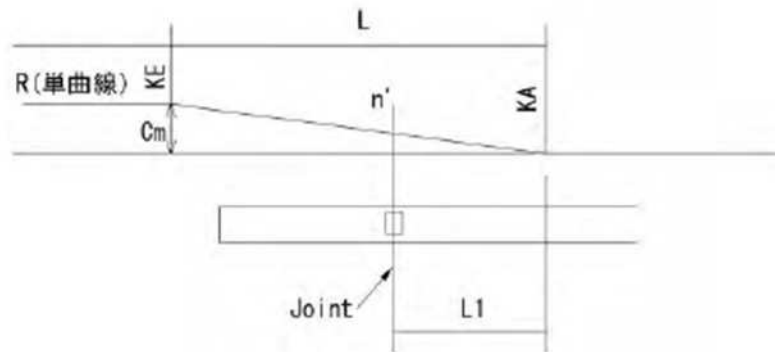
緩和曲線区間内の継手位置でのカント
